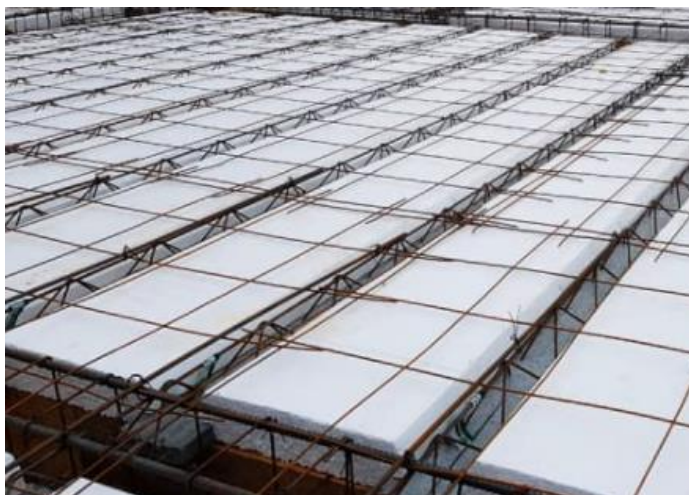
Laje treliçada com preenchimento em fôrma de EPS
